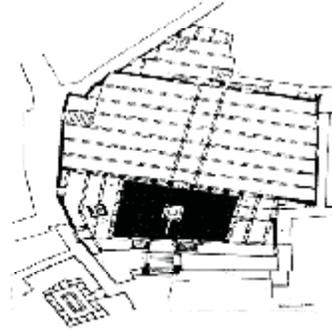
مسقط أفقي لجامع المنصور بقصبة مراكش
